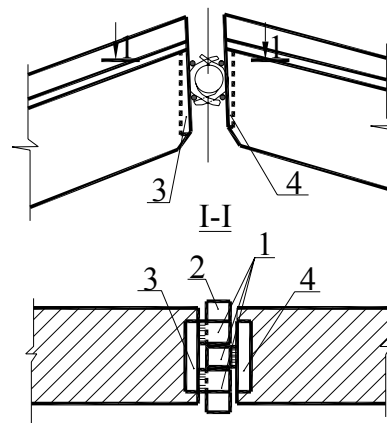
Коньковый шарнир железобетонной рамы [236]:
